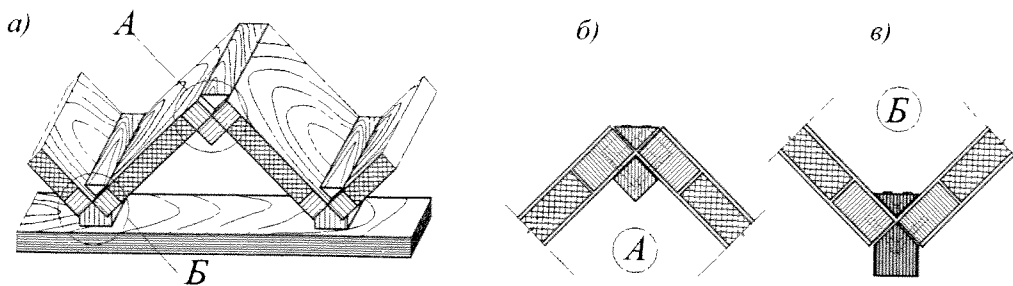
Деревянное складчатое покрытие треугольного профиля:
